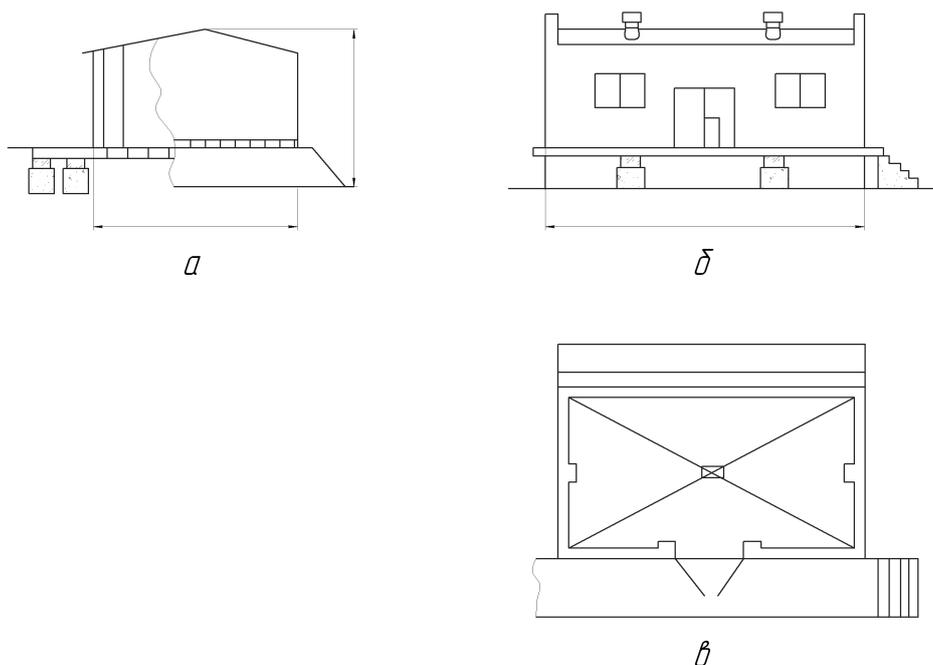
Здание хранилища с погрузочной рамкой: а – левый фасад с разрезом; б – передний фасад; в - план
